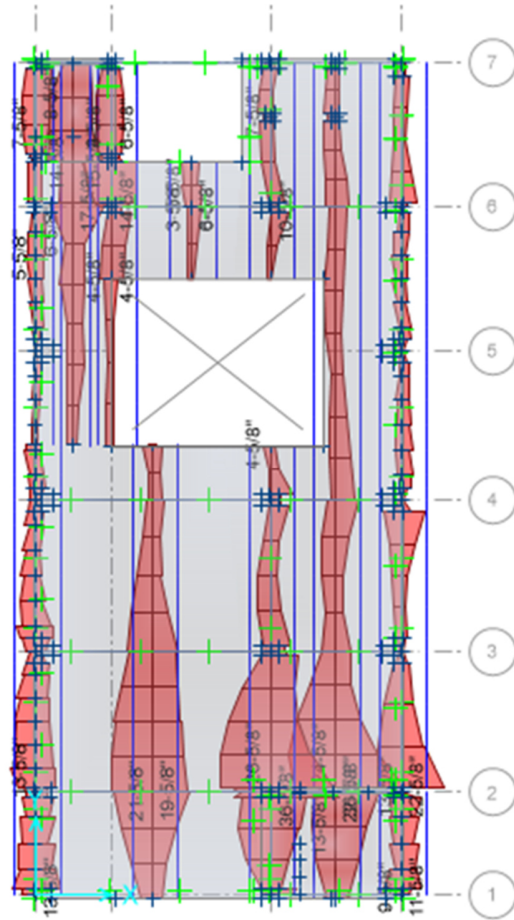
Refuerzo en Losa de Cimentación Eje Y-Y
